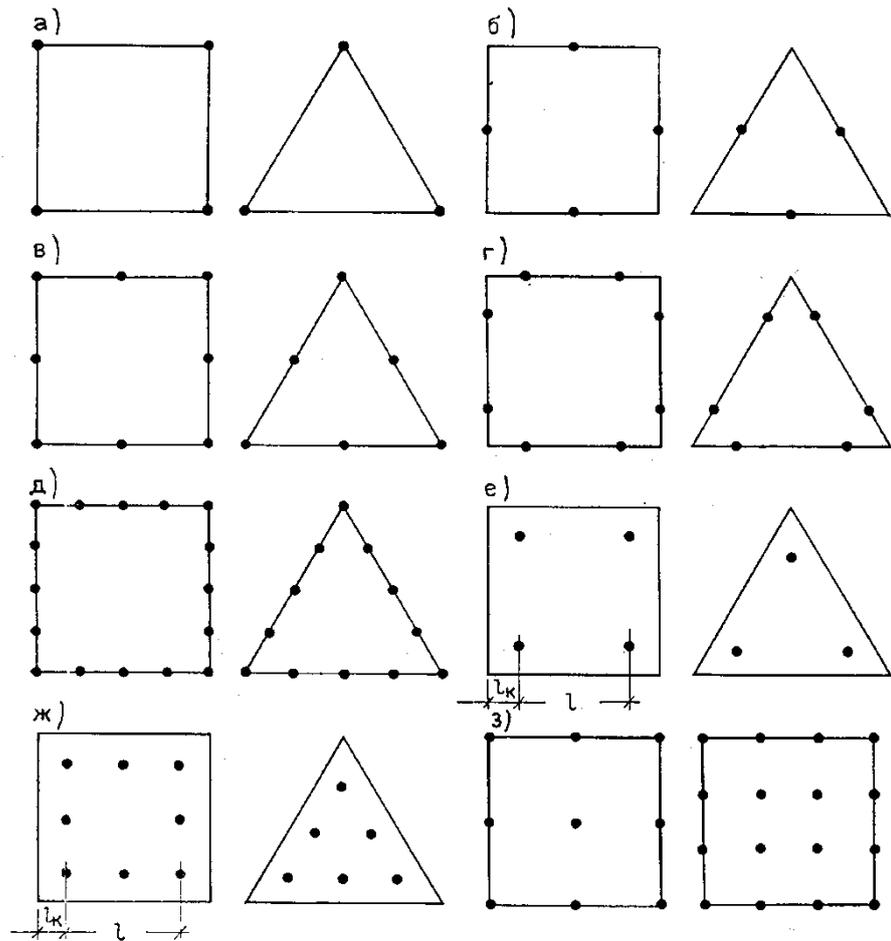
Варианты симметричного размещения колонн для покрытий из стержневых плит с квадратным и треугольным очертанием в плане:
